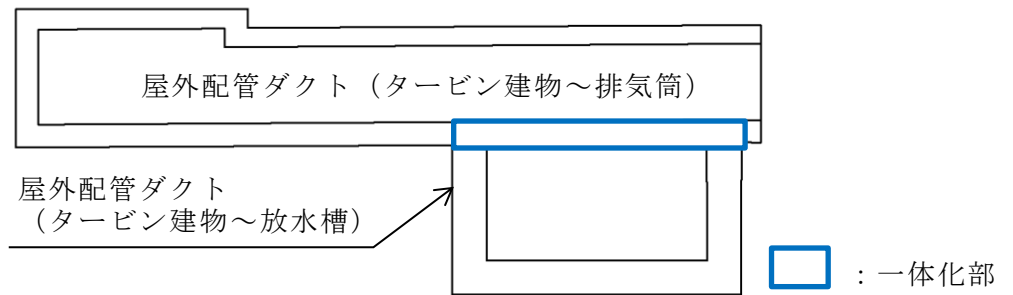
屋外配管ダクト (タービン建物～排気筒) 断面図 (C-C 断面)
